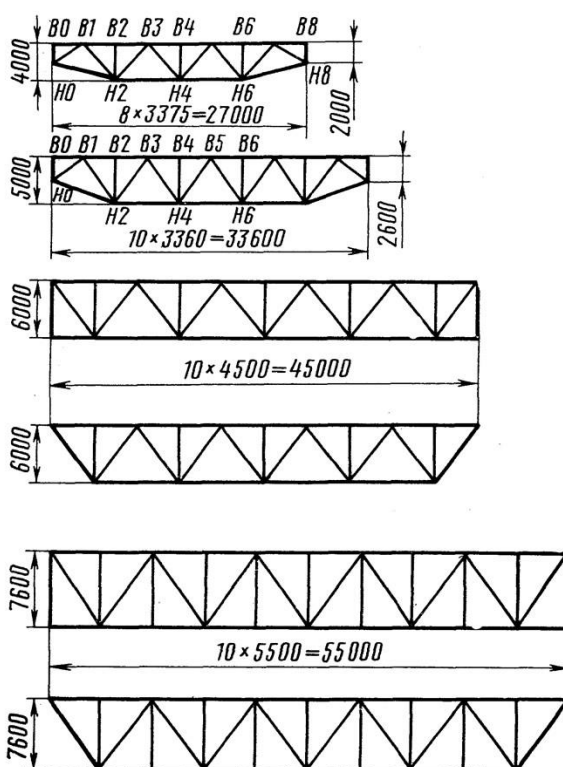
Схеми прогонових будов з їздою поверху
